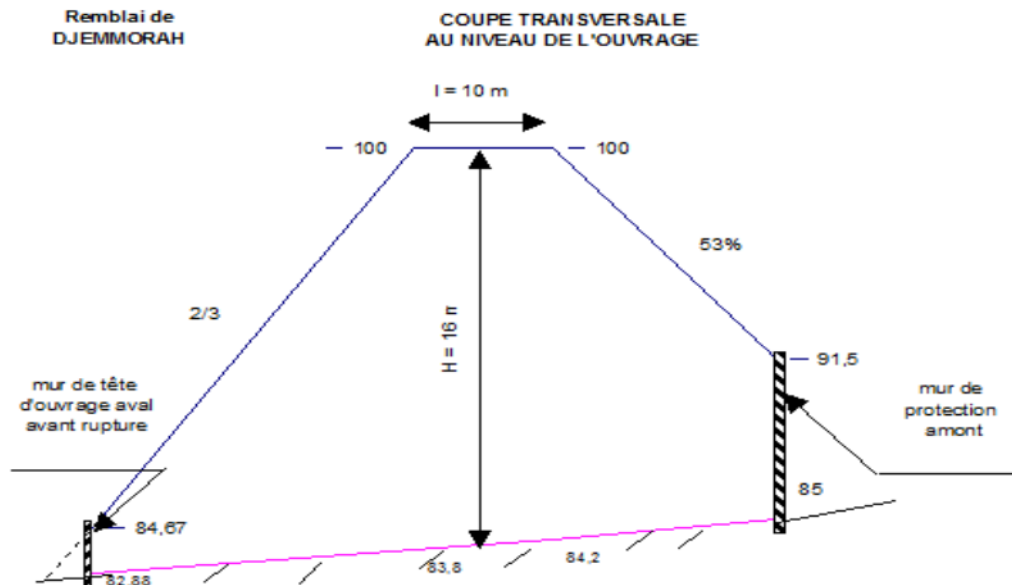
coupe transversale au niveau du l'ouvrage (remblai de djamourah).
